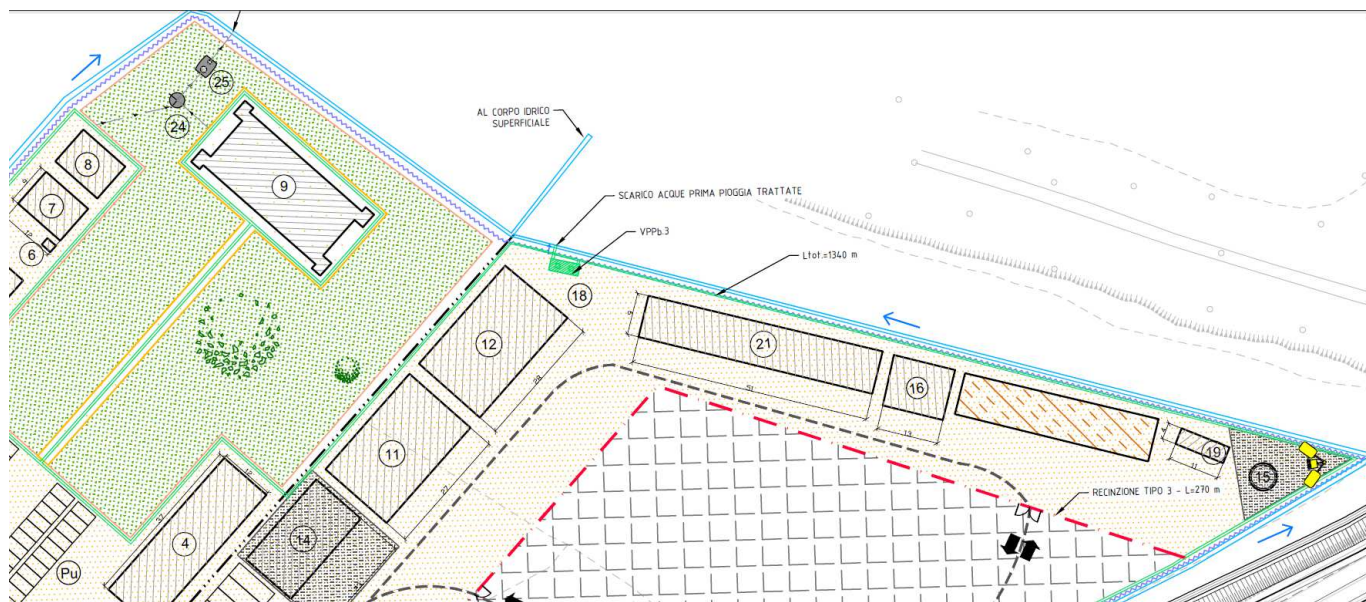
Stralcio planimetria aree di cantiere. In verde chiaro sistema di trattamento acque prima pioggia provenienti dal cantiere
